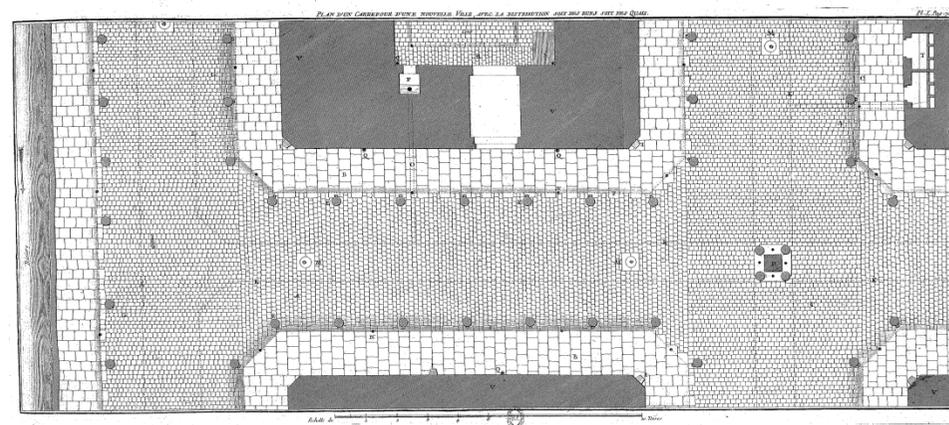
Planta de pavimentação do cruzamento de uma nova cidade, com a distribuição de ruas ou de cais, proposta por Patte (fonte: PATTE, 1769).
